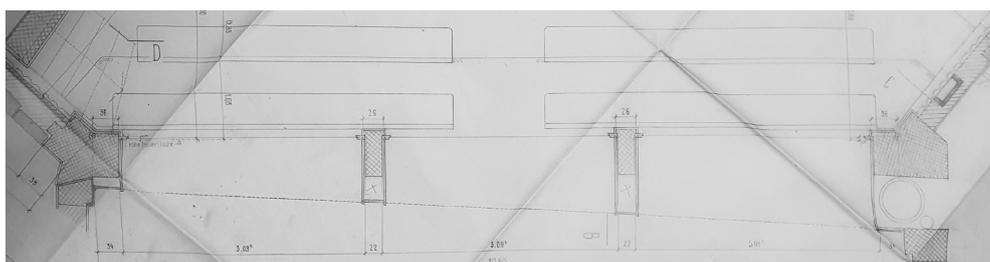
Grundriss Auf der Kirche / Gemeindesaal - Das Lüftungsrohr rechts in der Wand
